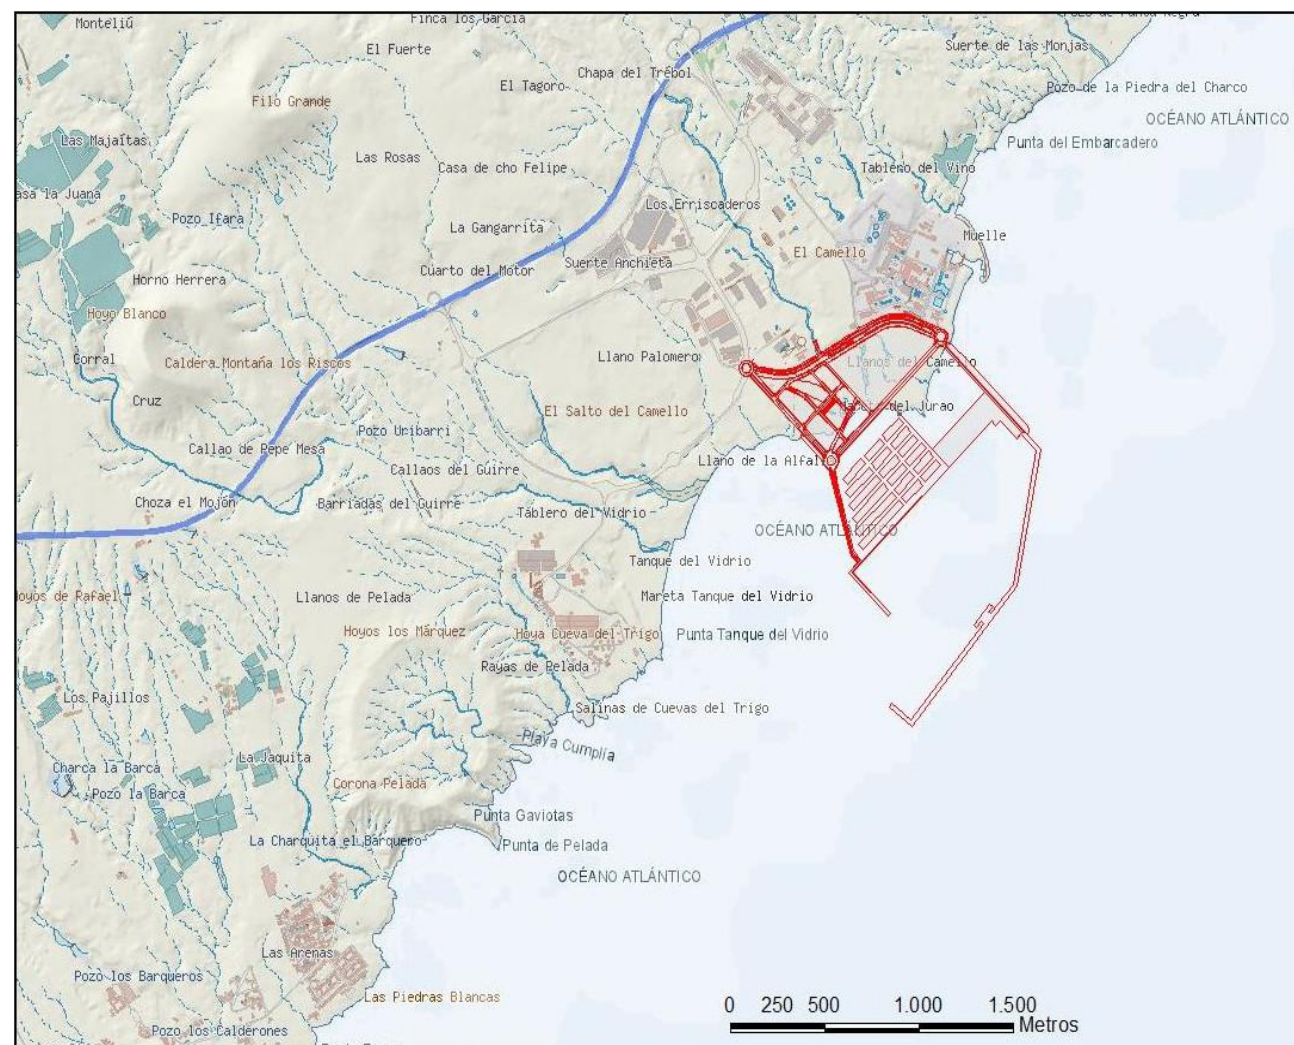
Detalle gráfico de planta del Puerto de Granadilla. Fuente: OAG.
